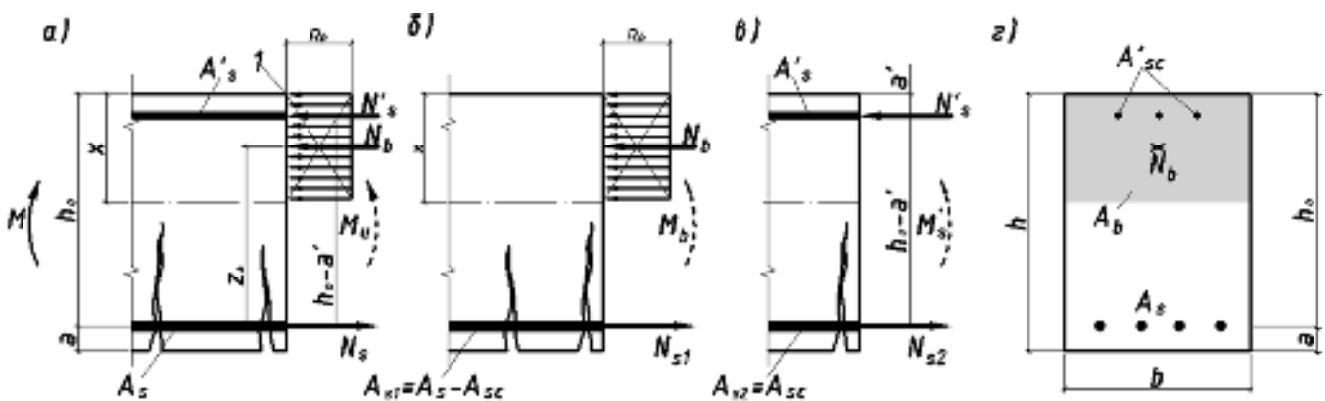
Схема усилий и напряжений в нормальном расчетном сечении прямоугольных элементов с двойной арматурой:
